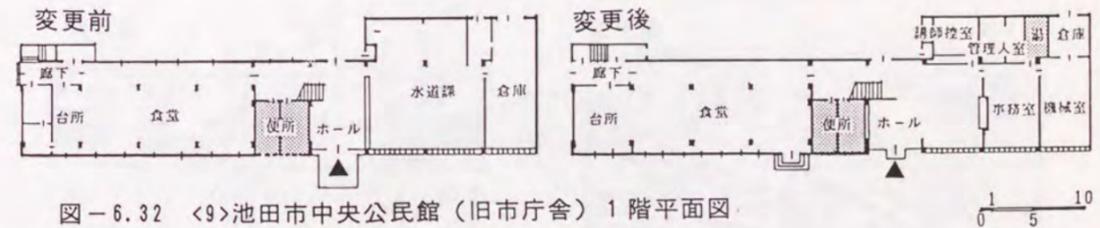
<9>池田市中央公民館(旧市庁舎)1階平面図
